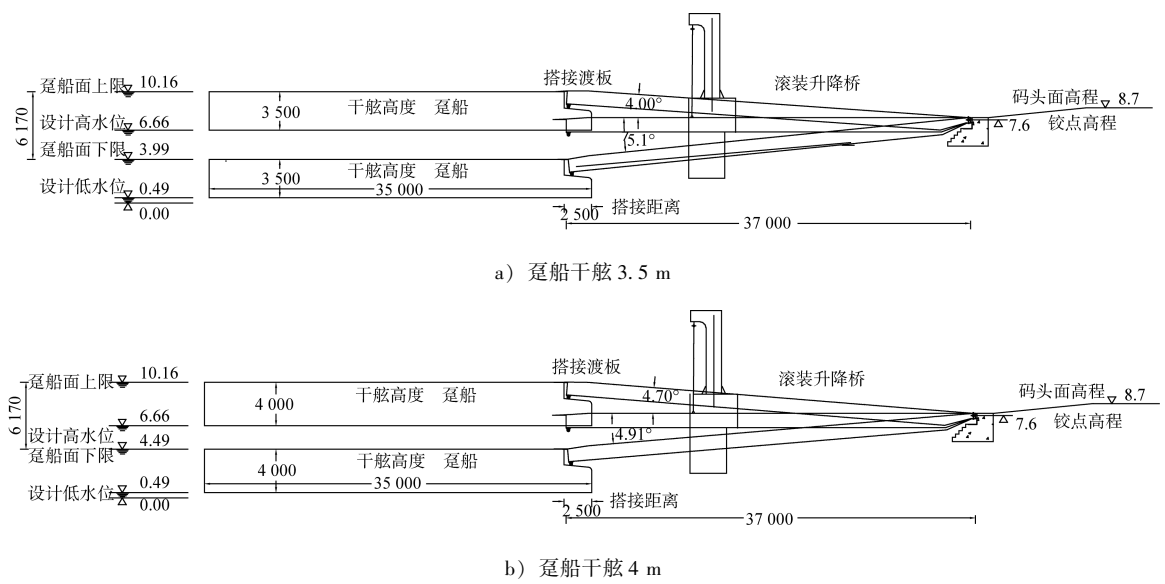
汽车滚装船接岸设施立面图 (高程: m; 尺寸: mm)
